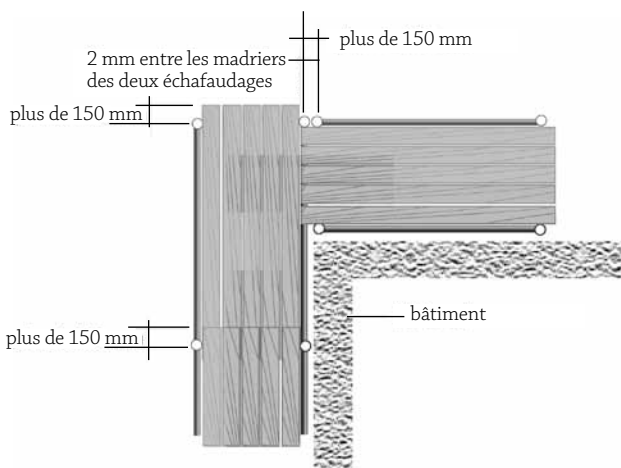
Installation de madriers sur des échafaudages placés en angle
